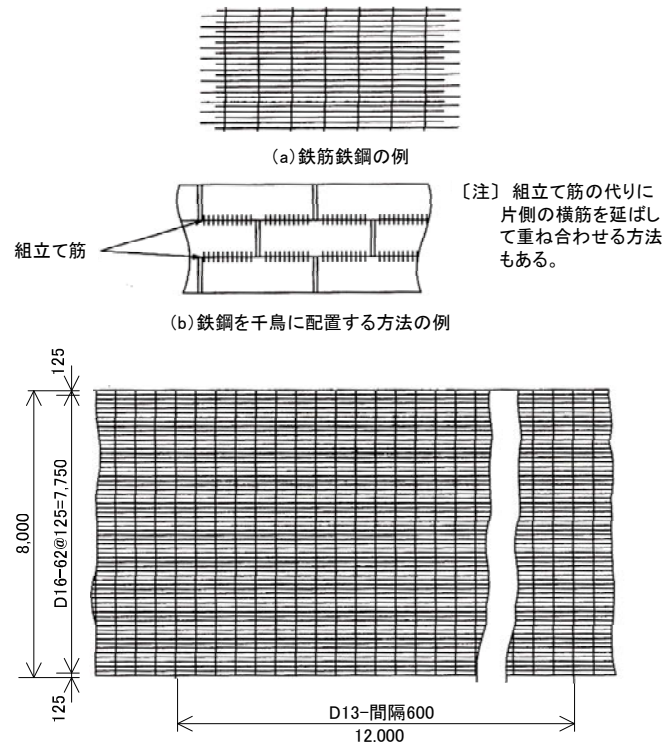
Ⅲ-25 連続鉄筋コンクリート版の配筋(単位: mm) (参考)
